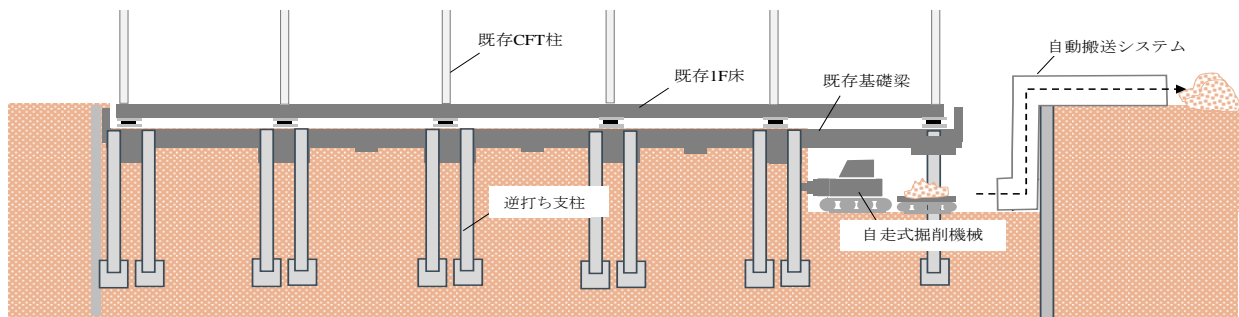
技術研究所本館地下の雨水貯留施設の施工法の構想
